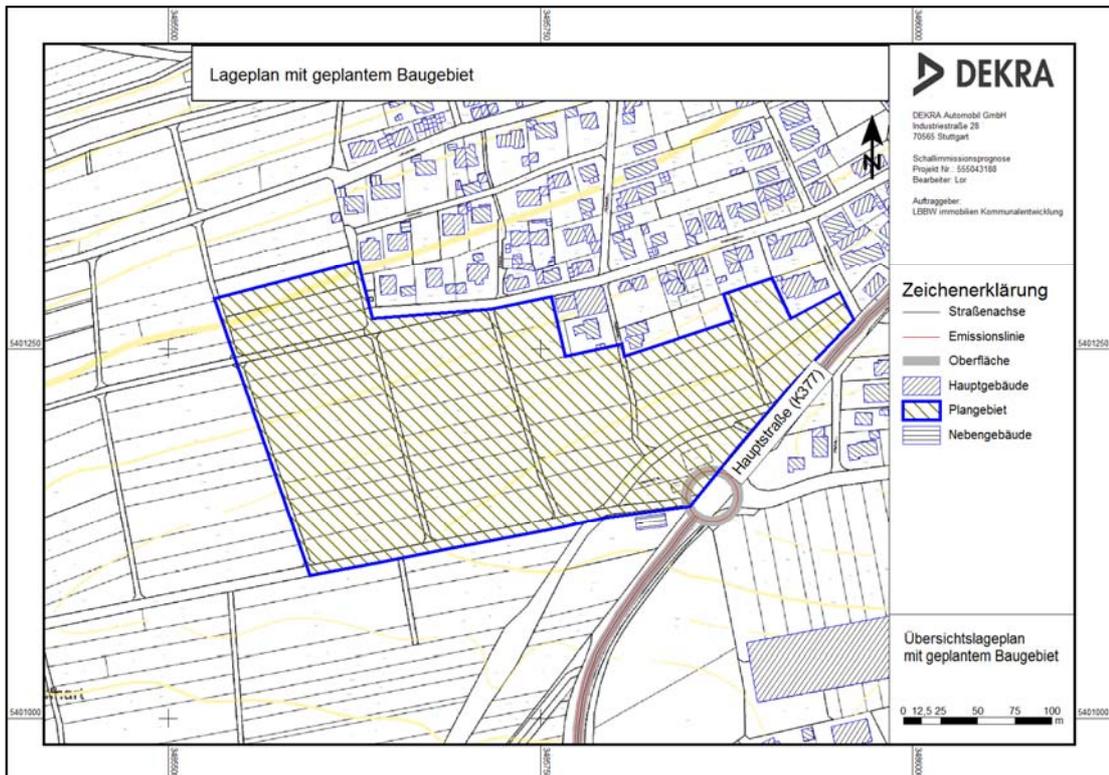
Übersichtslageplan mit geplantem Baugebiet
